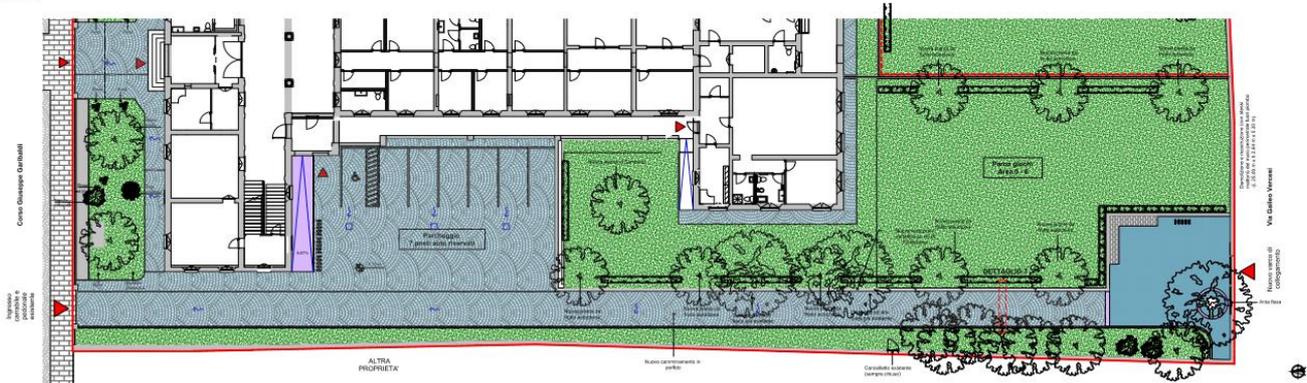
Riqualficazione area ad Ovest e nuovo camminamento
